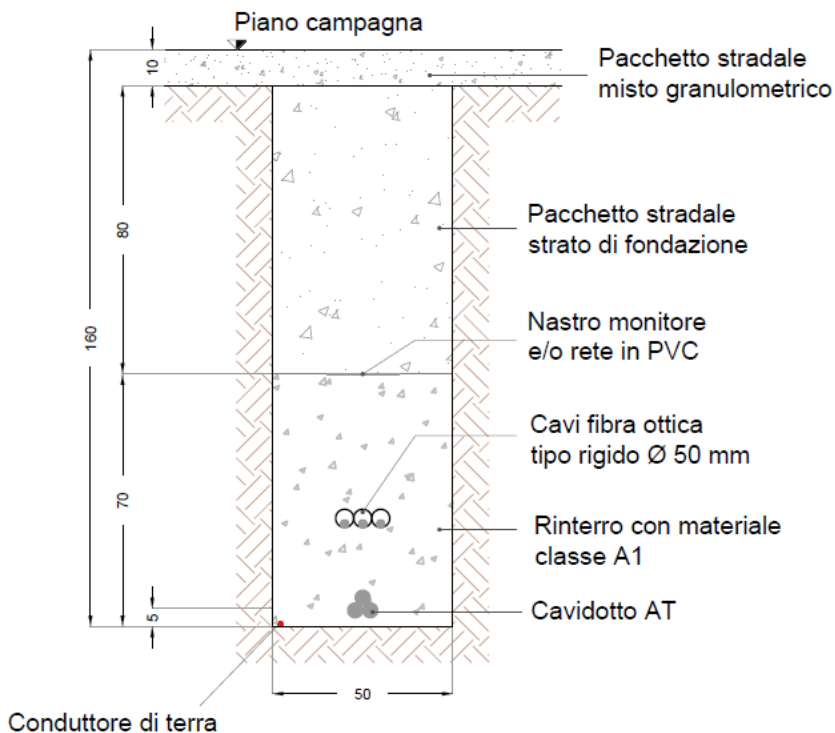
Sezione tipo cavidotto AT una terna su strada sterrata
